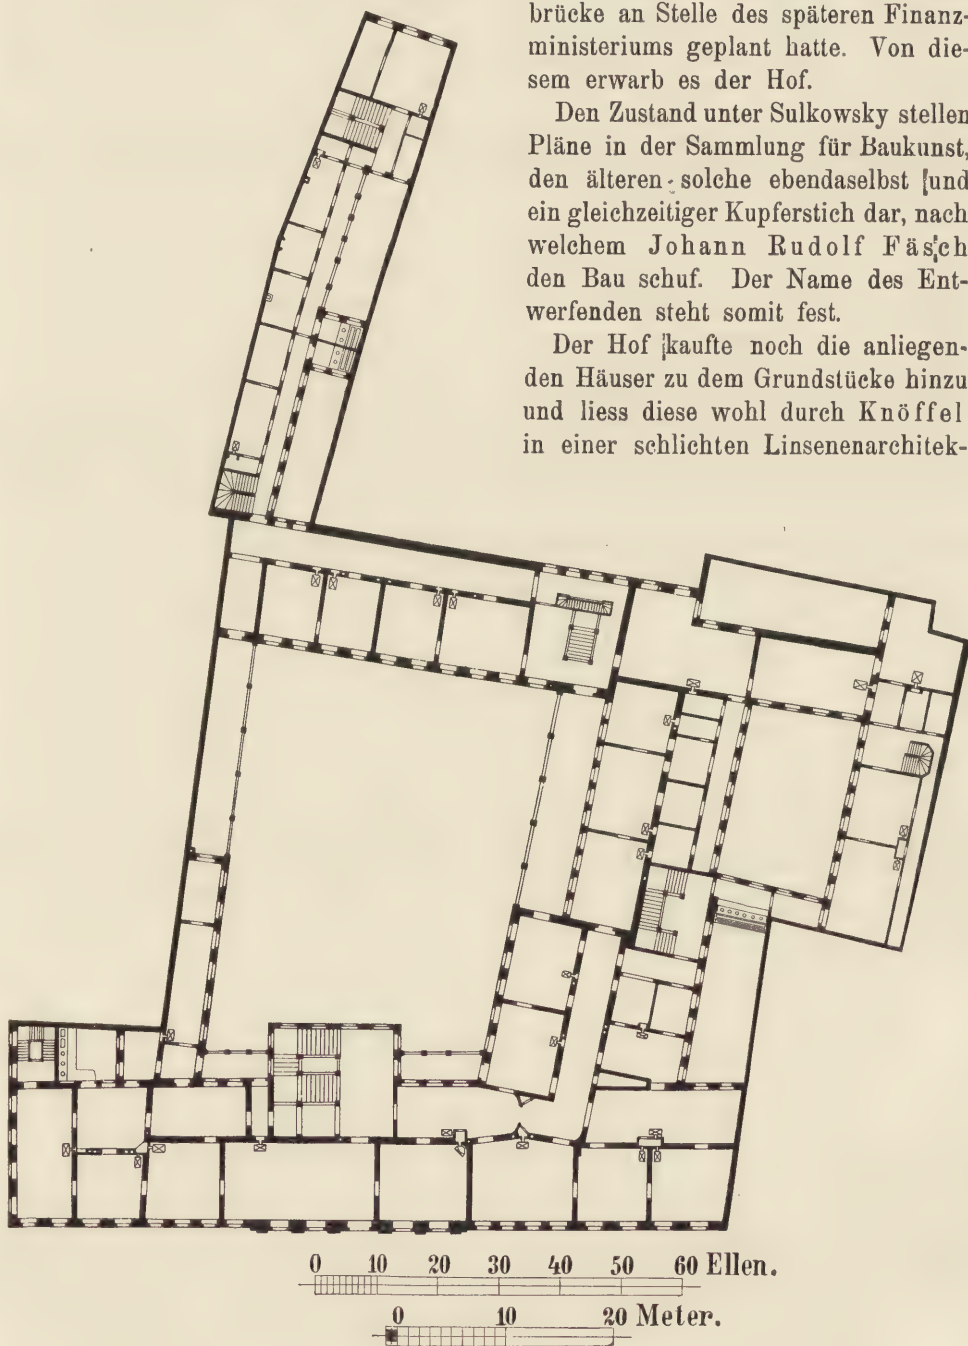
Flemming'sches Palais, Grundriss des 1. Obergeschosses. Zustand von 1747.
